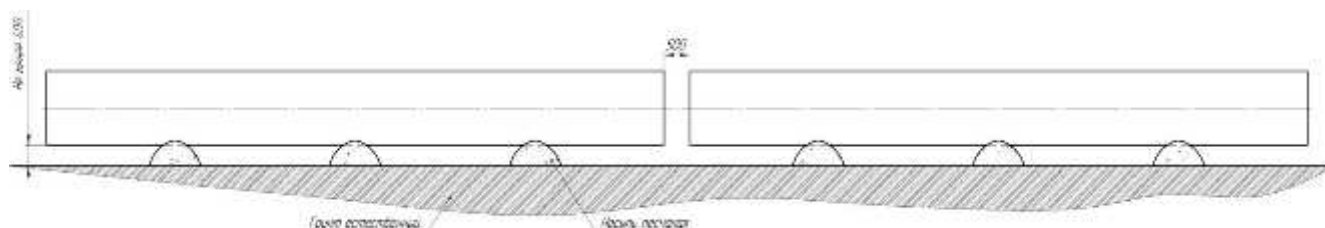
Схема укладки труб на песчаные насыпи
